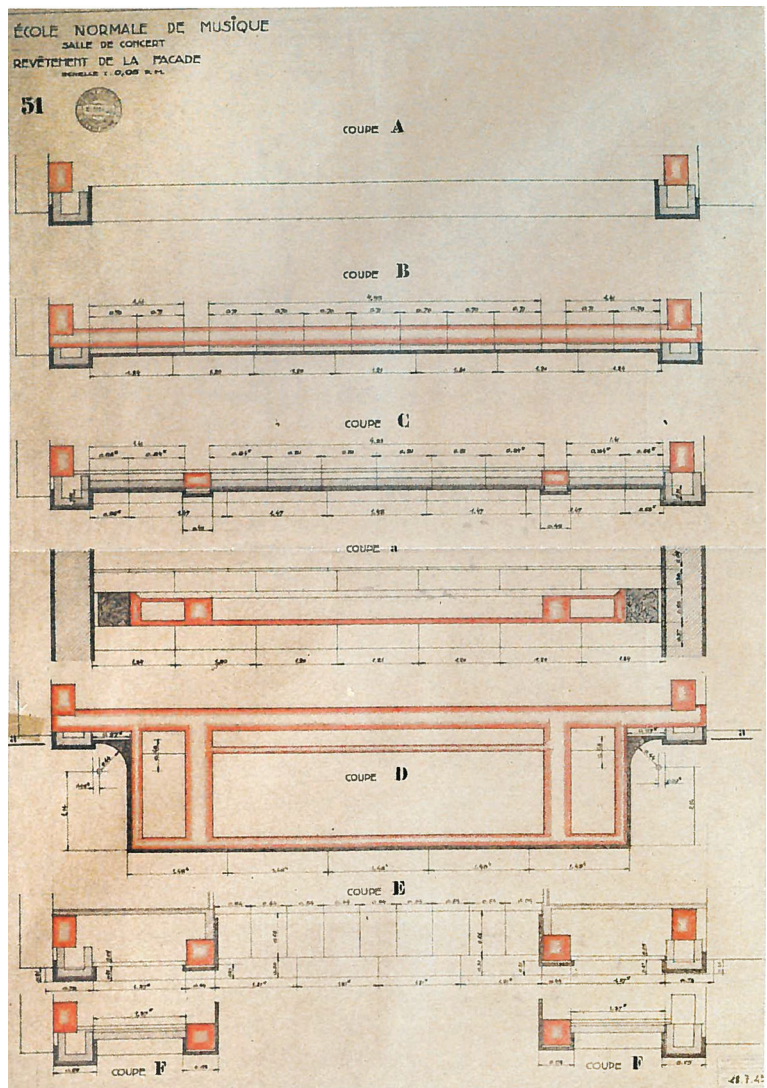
Sala Cortot, cortes construtivos horizontais da fachada sobre a rua
